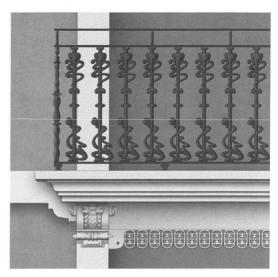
Alzado de un balcón modernista perteneciente al siglo XX, Calle de Las Rocas
